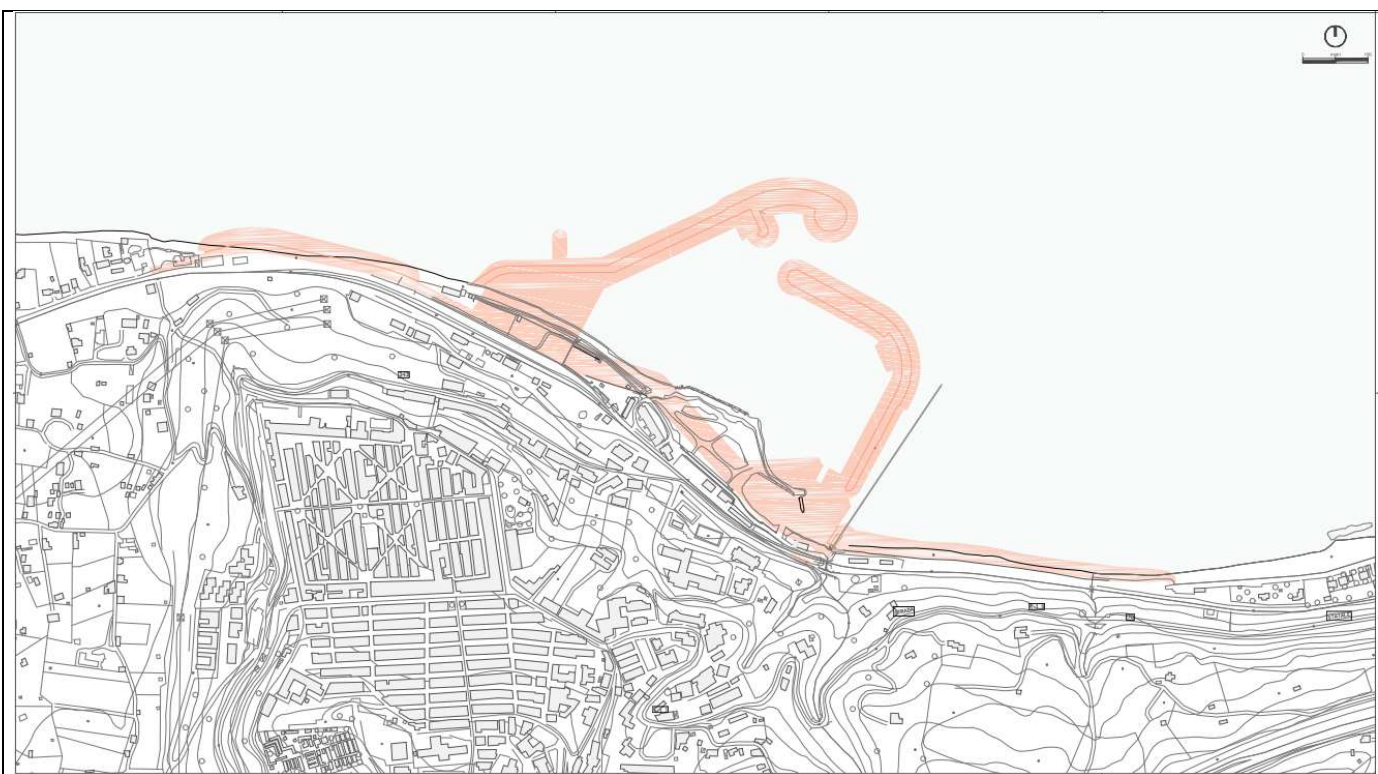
Inquadramento planimetrico di progetto con impronta della situazione attuale.
